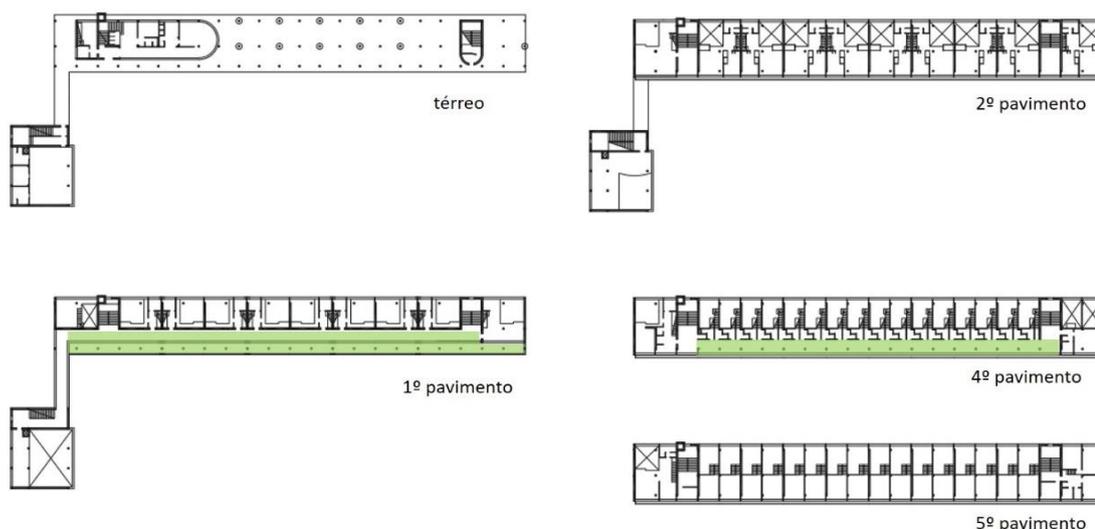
Plantas baixas de pavimentos tipo- Narkomfin.
